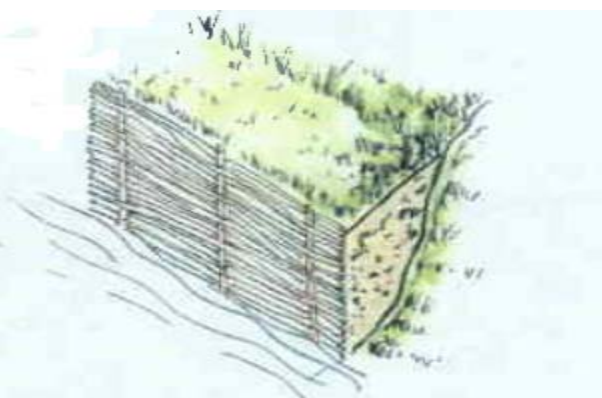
Mbrojtja e brigjeve me drunjë të gjallë <http://www.goldenvalleymn.gov/stormwater/stream-bank-stabilization.php>
